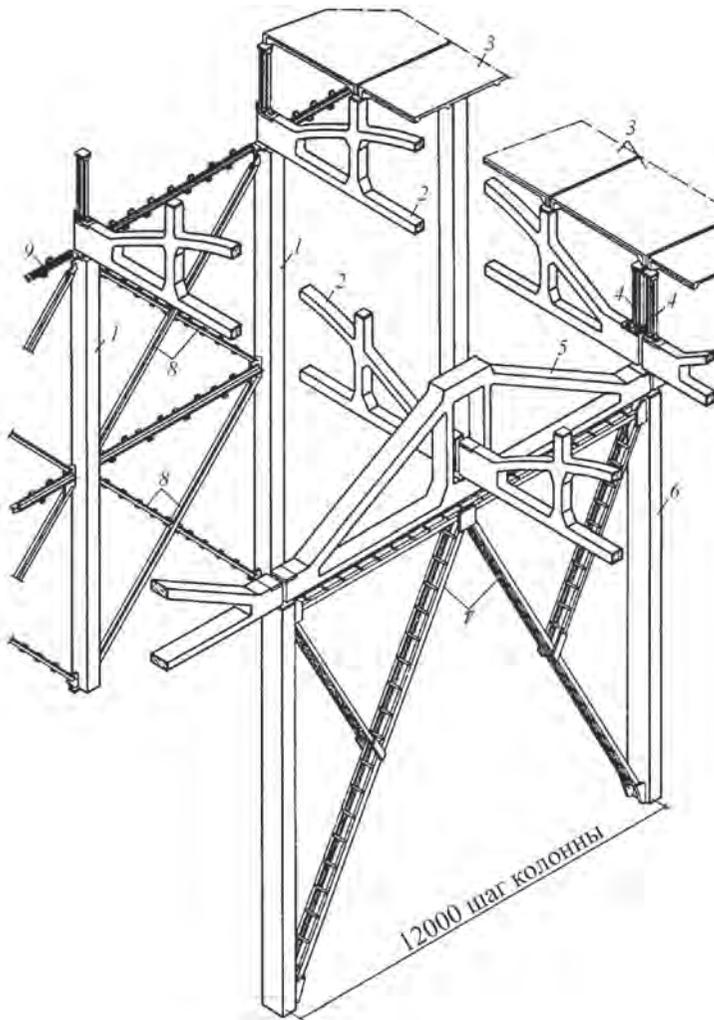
Фрагмент каркаса одноэтажного здания ($H = 12; 13,2; 14,4$ м) с подстропильными фермами и связями:
